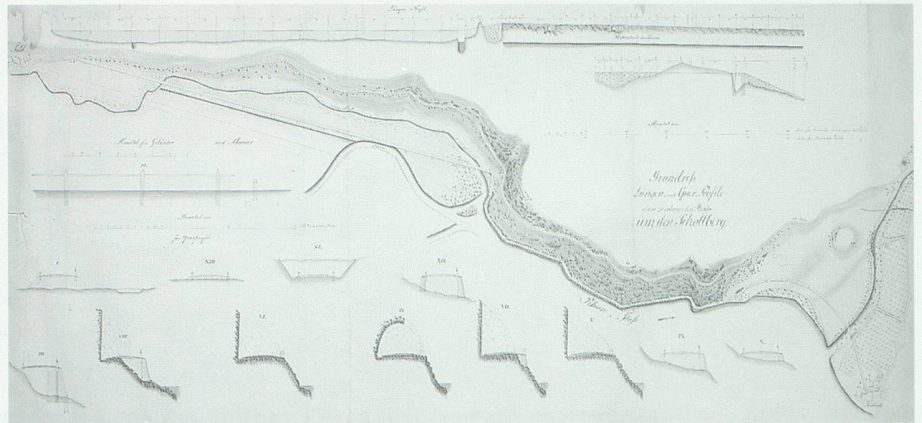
«Grundriss, Längen- und Querprofile einer zu erbauenden Strasse um den Schollberg»; 1821.
